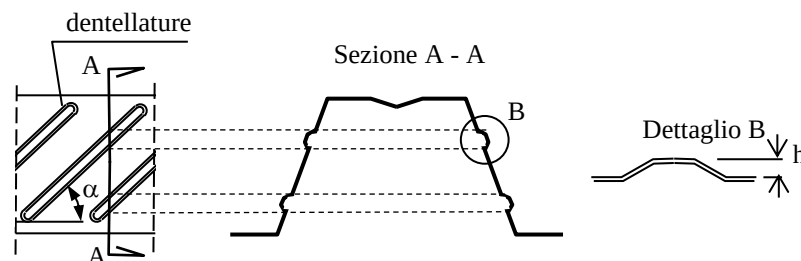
Lamiera con rilievi (dentellature) longitudinali
